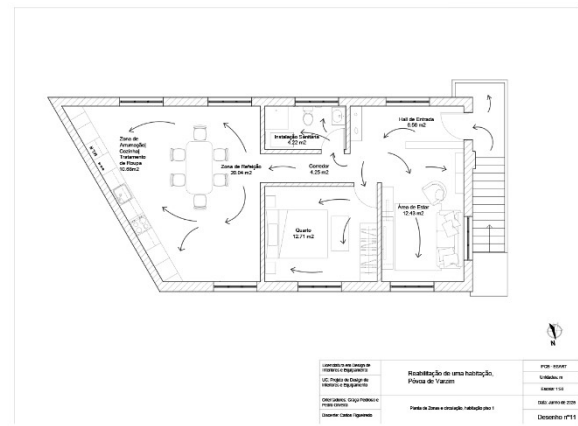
Planta de Circulação Habitação Piso 1. Fonte: Autor.
